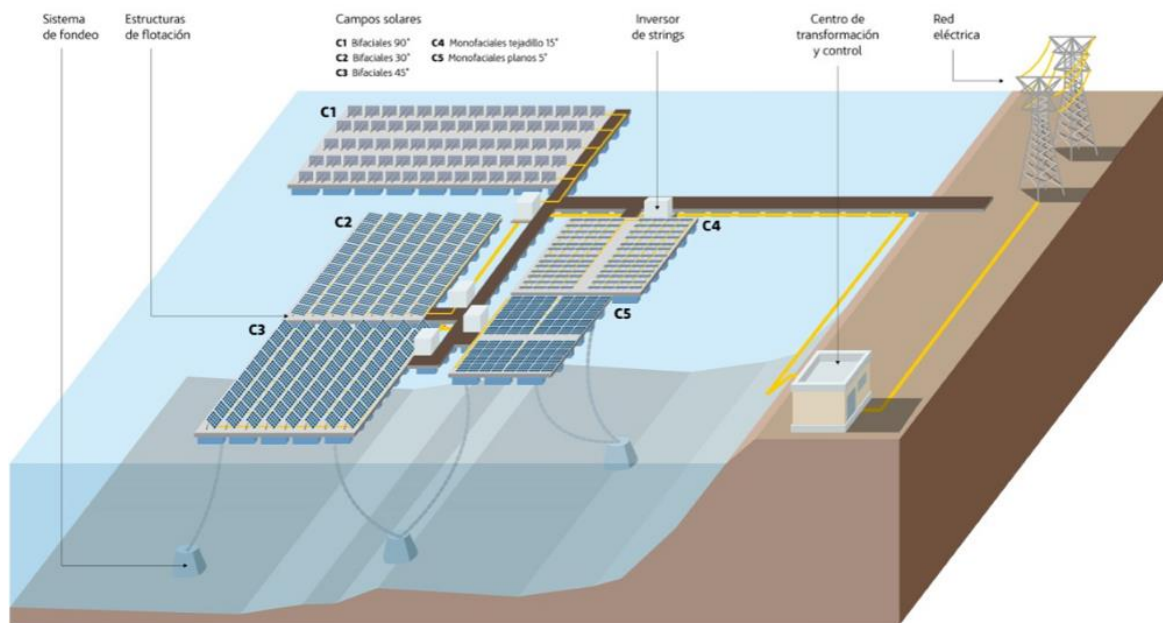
Modelo en 3D de la planta fotovoltaica de Sierra Brava. Fuente: Acciona.
